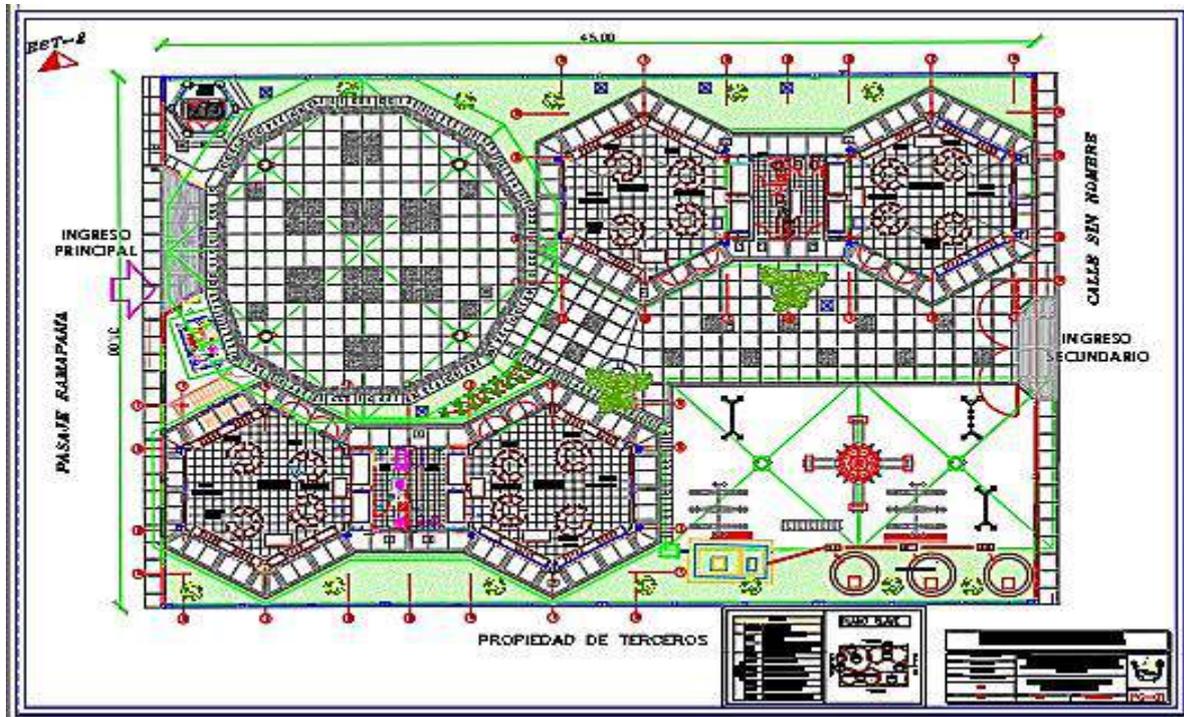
Plano donde se evidencia los bloques en construcción como Bloque 01, bloque 02 primer nivel, obra exterior n° 01, obra exterior n° 02, obra exterior n° 04, obra exterior n° 05 y obra exterior n° 06. Elaboración propia.
